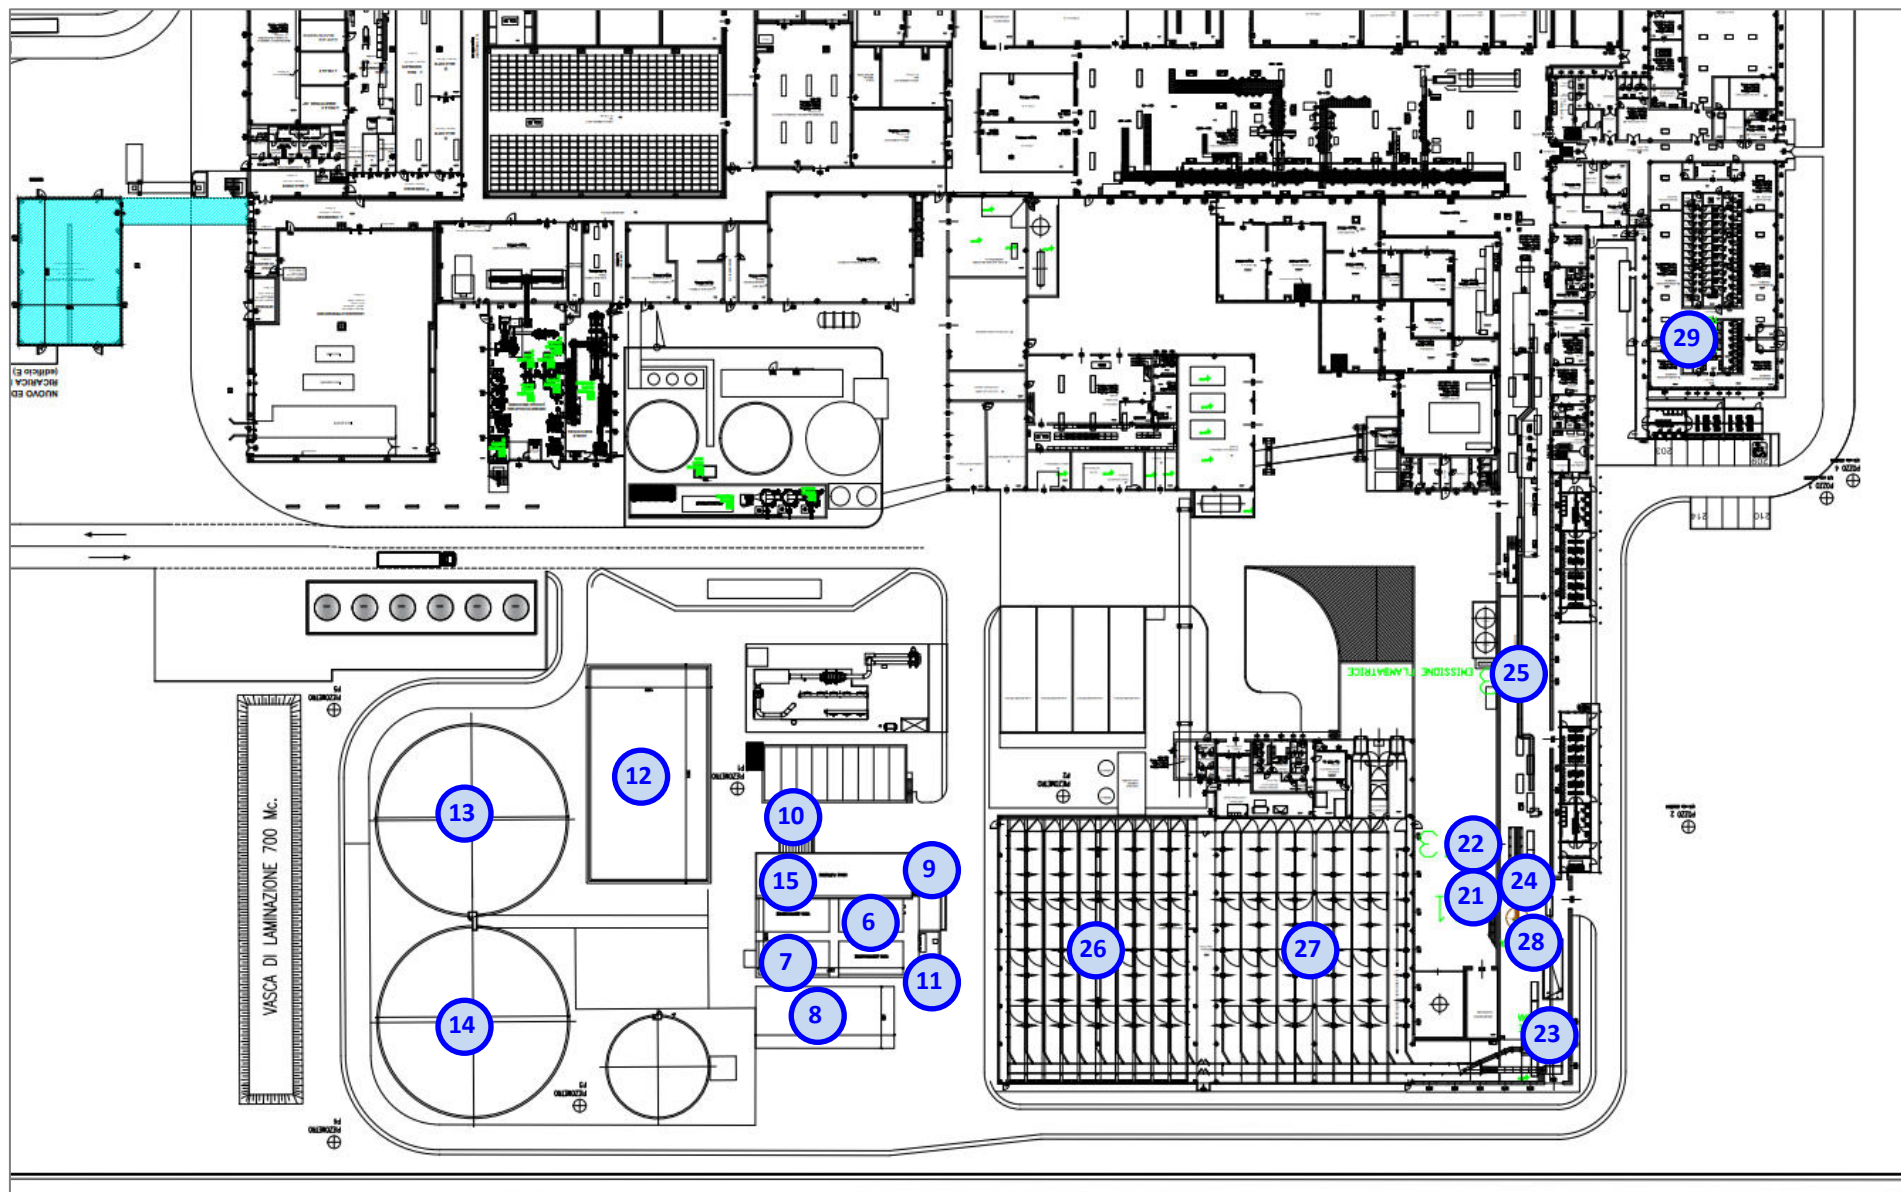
Stralcio di planimetria dei punti emissivi campionati
